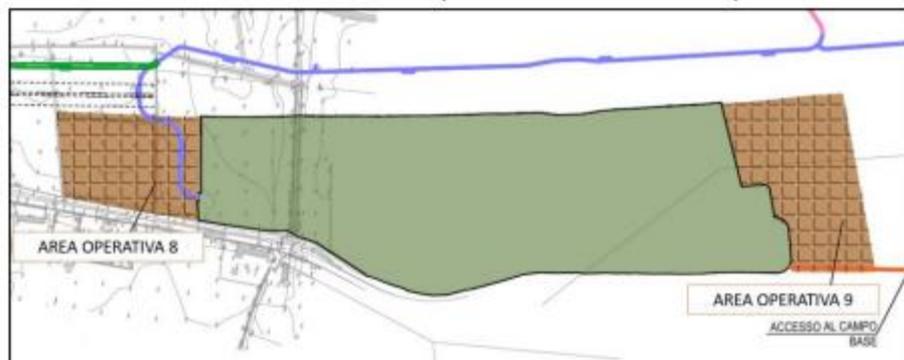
Stralcio planimetrico Aree Operative 8 e 9
